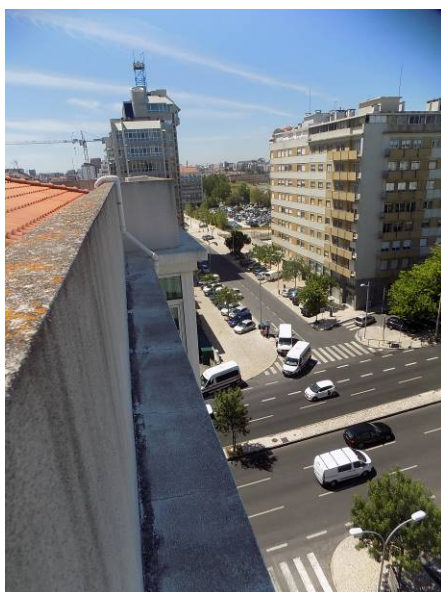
Idem. Idem. Outro exemplo de manchas de colonização biológica no coroamento do muro de platibanda (lado poente). Fissuras dispersas na parte superior da cornija da fachada poente.
